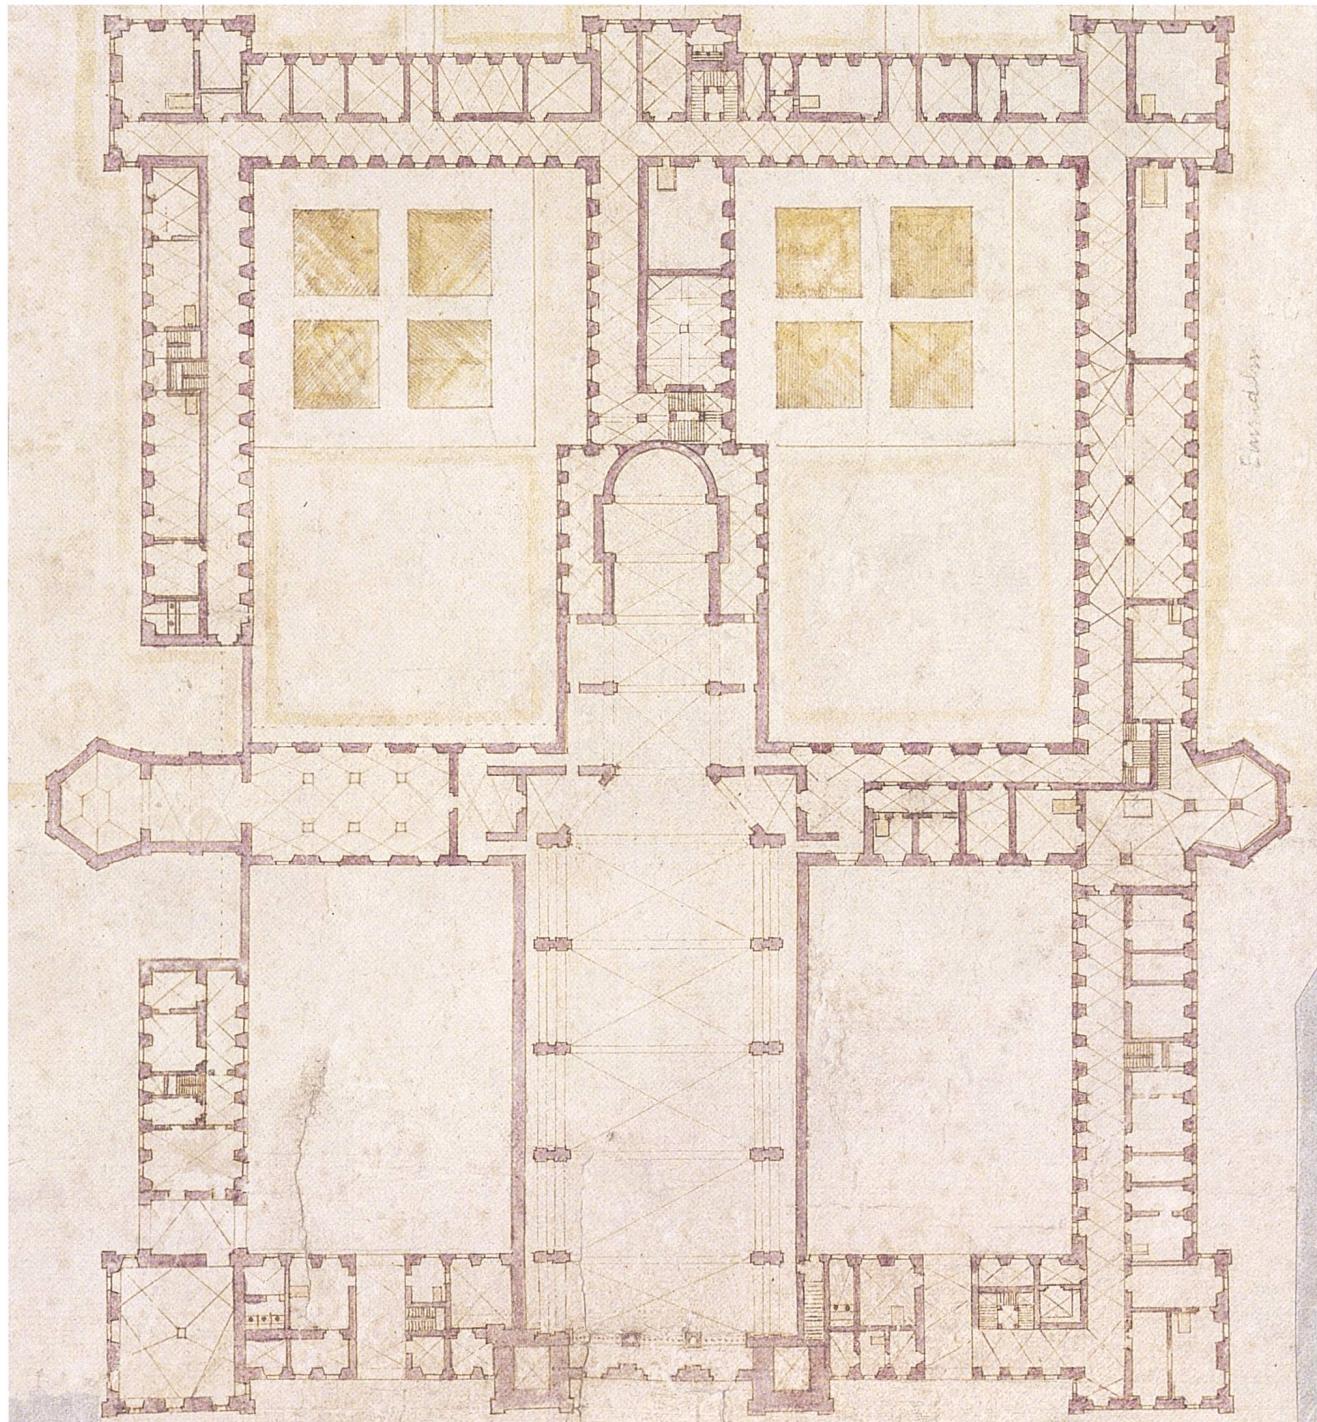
Der als Gutachter eingeladene Baumeister Franz Beer präsentiert 1703 einen eigenen Klostergrundriss. ZHB, PLb 1:1.
